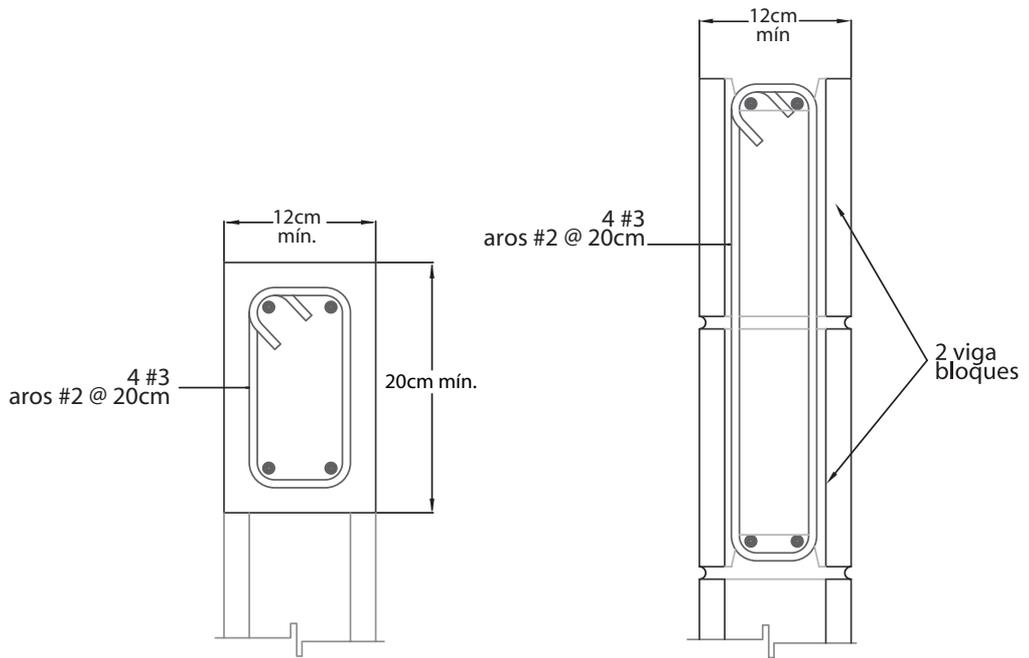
Vigas corona mínimas en paredes de mampostería.
